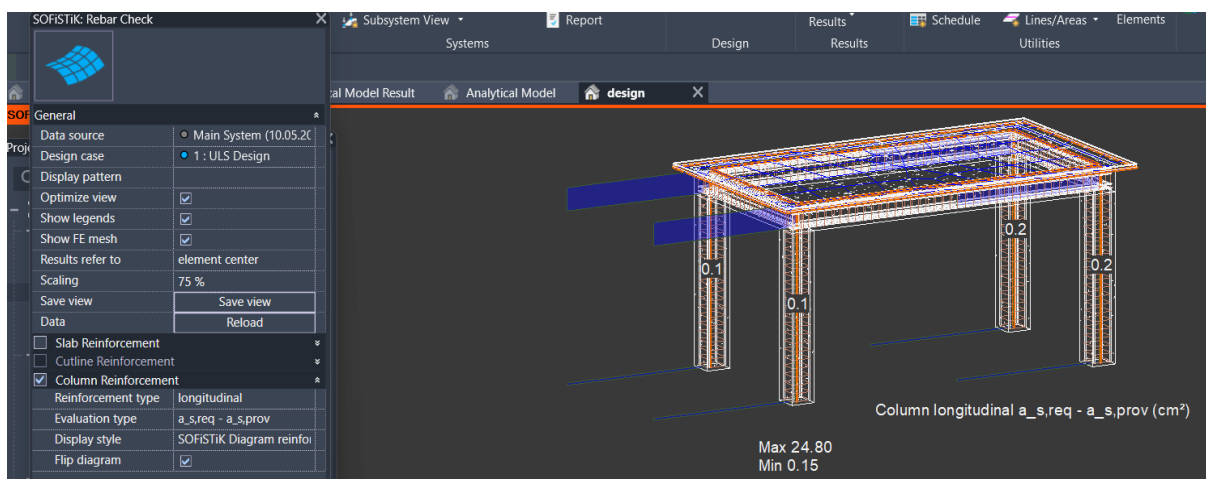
Armering og detaljering av armeringen ble gjort ved bruk av Revit og SOFiSTiK Reinforcement
